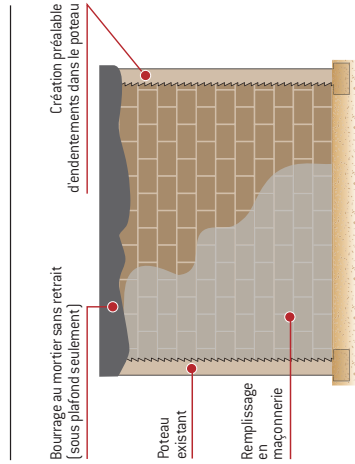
Création d'un mur en maçonnerie entre 2 poteaux existants (élévation)
